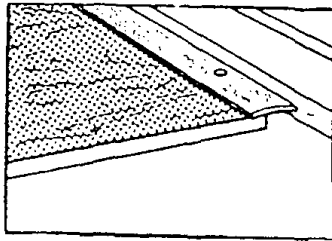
Укладка металлической накладки на стыке двух видов покрытий
